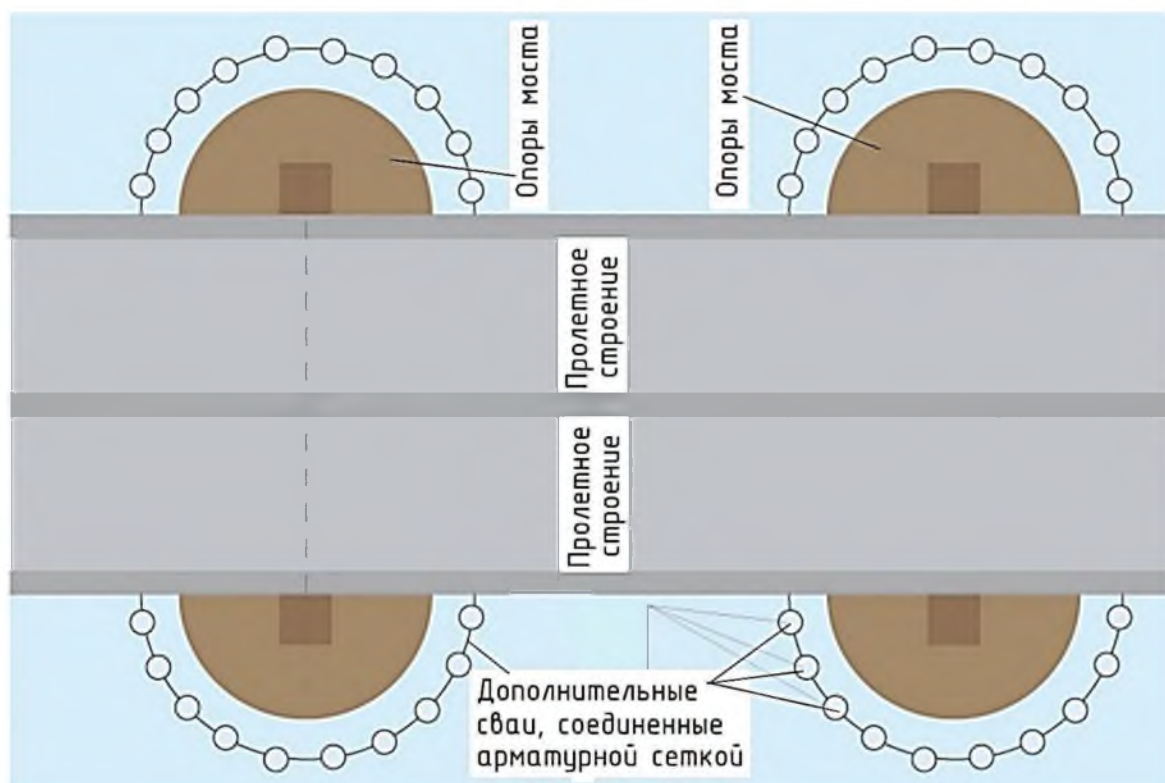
Вариант схемы размещения в плане дополнительных свай, соединённых с арматурной сеткой, для защиты опор Крымского моста
